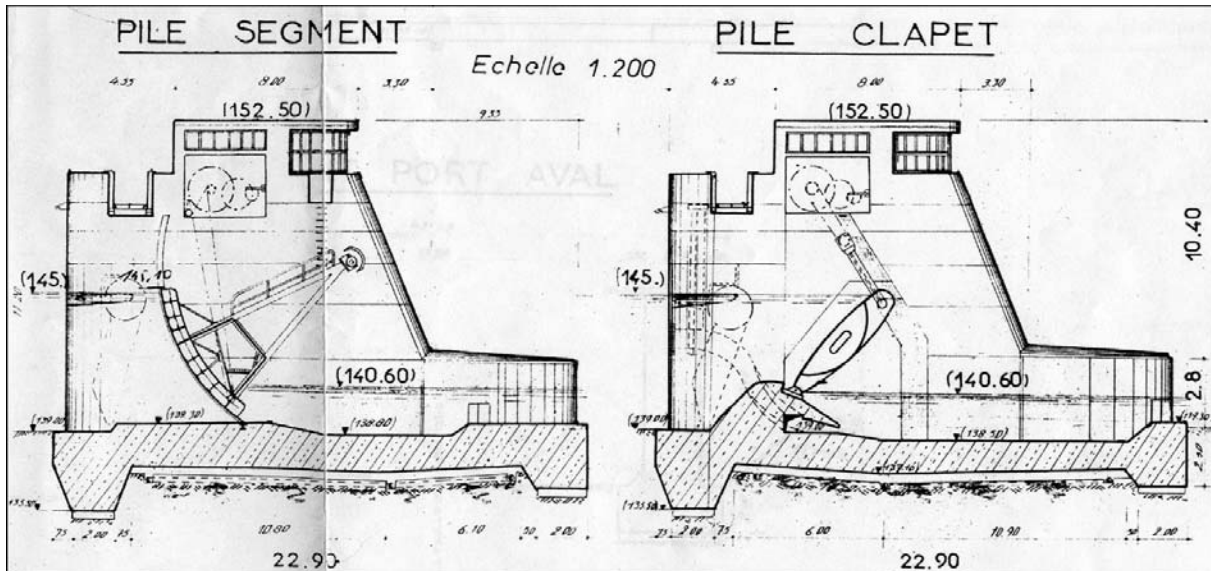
Vue en coupe des piles segment et clapet du barrage d'Apach (cotes NGF)
